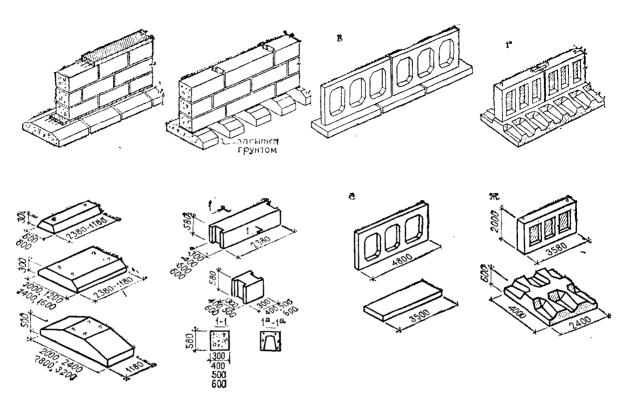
Сборные бетонные и железобетонные фундаменты
